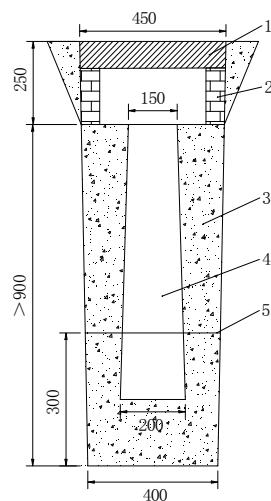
混凝土水准基点（工作基点）标石（单位: mm）
